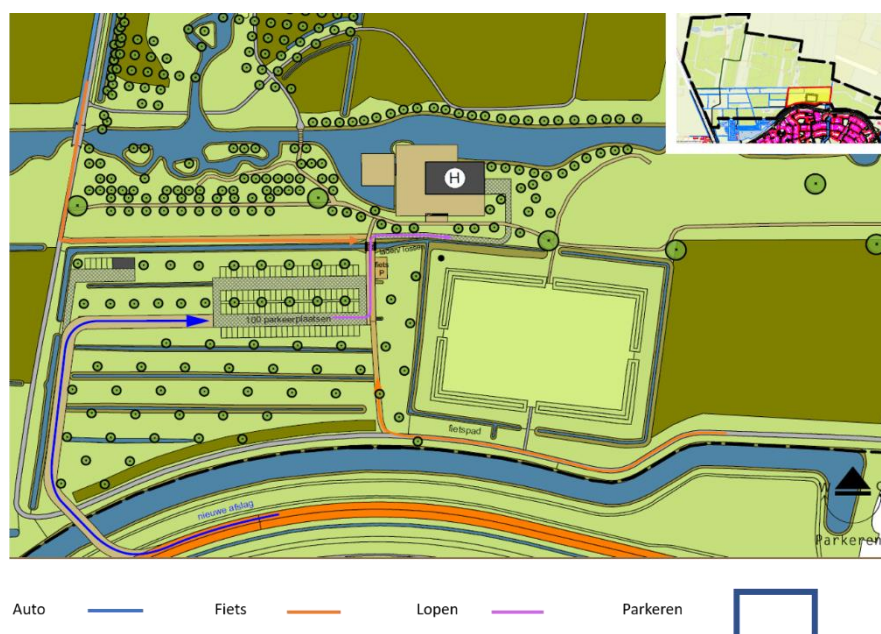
Plan voor parkeren en horeca Het Nieuwe Bos Wulven
